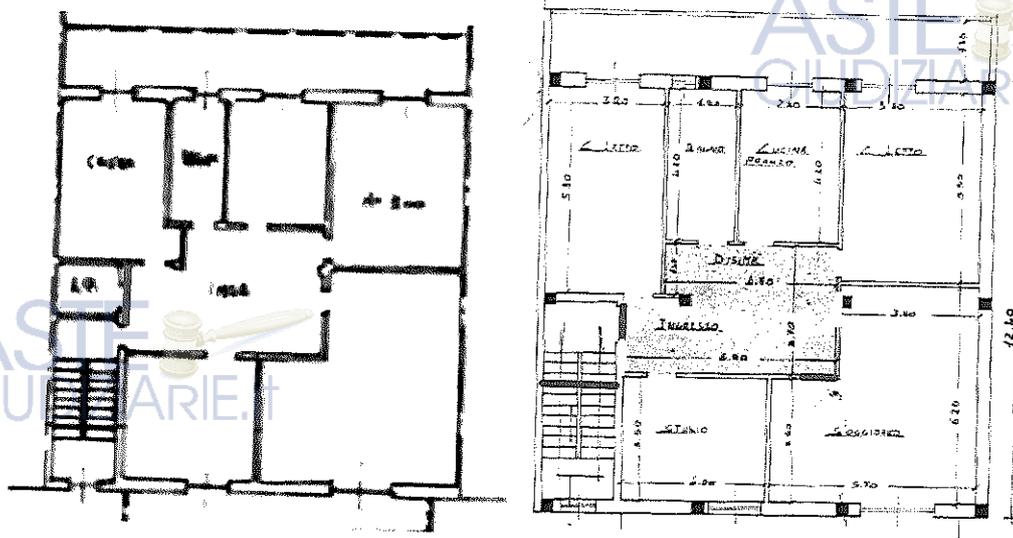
difformità confronto tra planimetria catastale e di progetto
